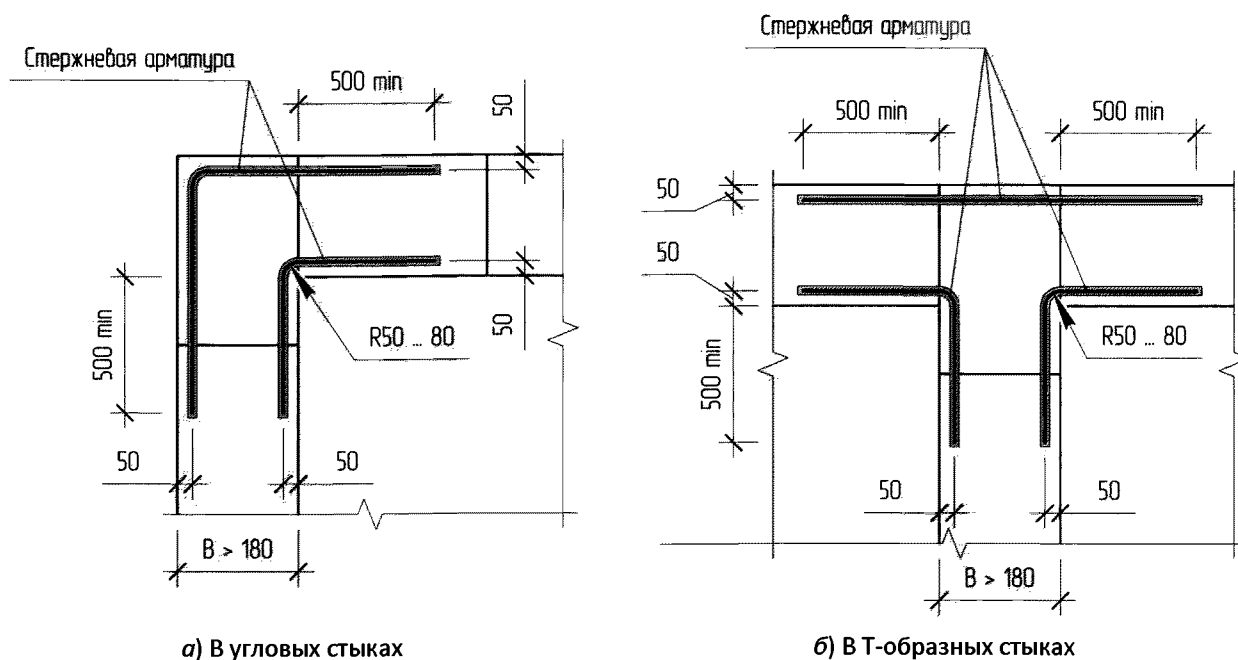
Пример раскладки арматурных стержней на пересечении стен (при толщинах стен более 180 мм)
